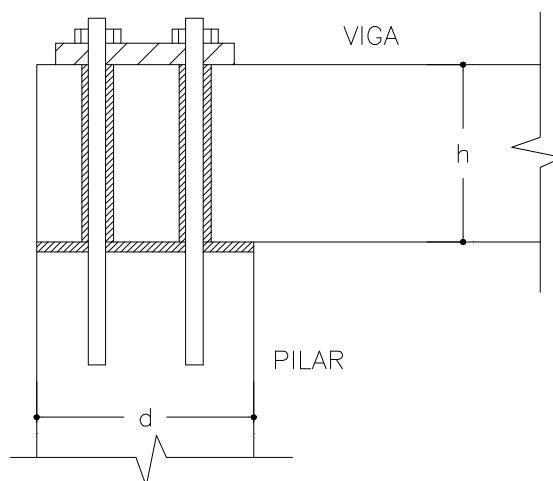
Ligação Rígida Pilar-Viga de Topo
